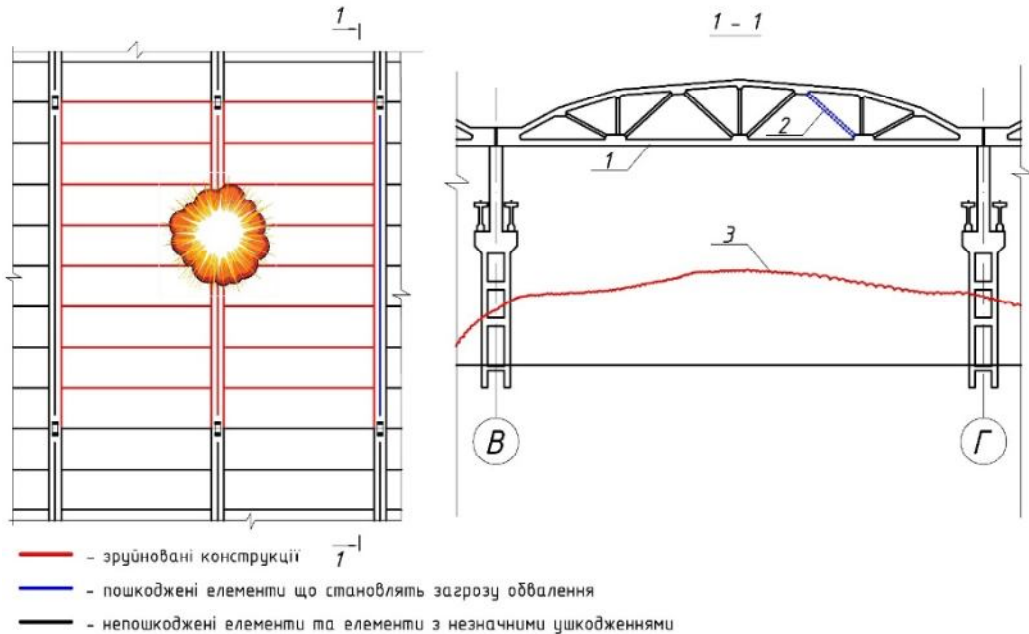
Схема пошкоджень промислової будівлі внаслідок впливу, не передбаченого при проектуванні: 1 – пошкоджена конструкція (залізобетонна ферма); 2 – місце пошкодження конструкції (розкос); 3 – зруйновані конструкції
